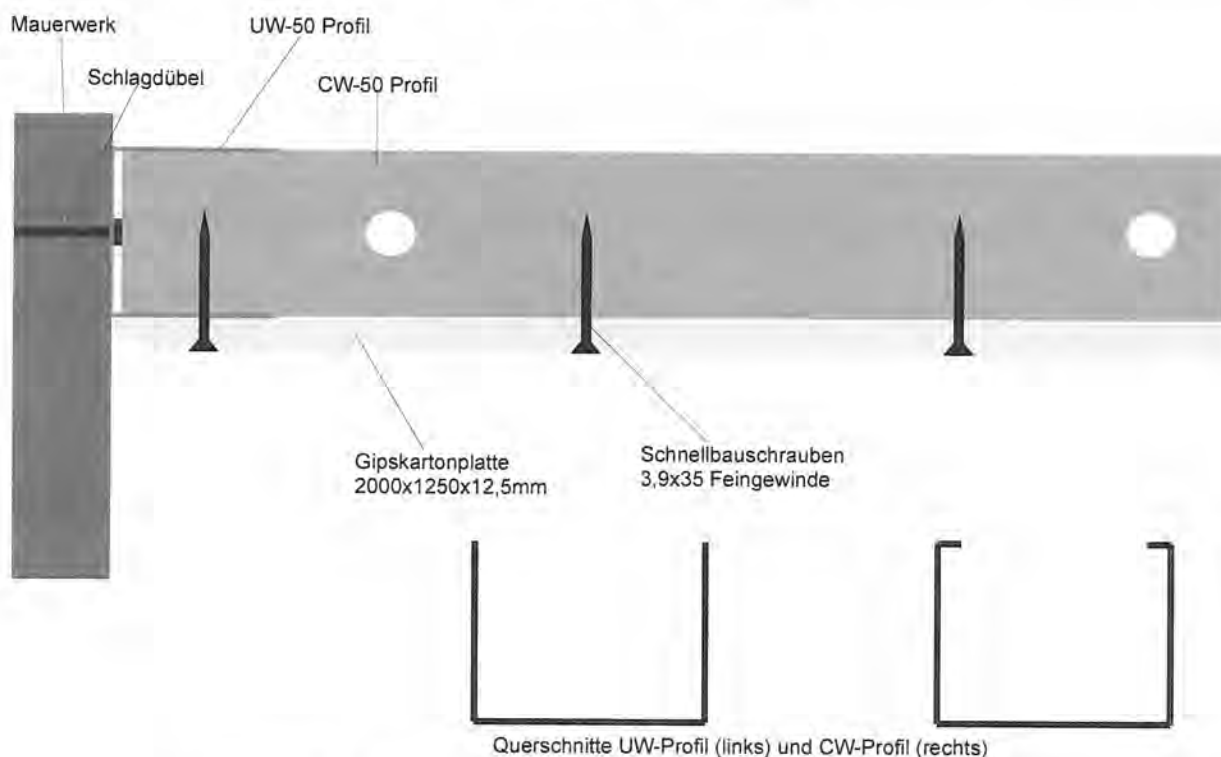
Trockenbau-Deckenkonstruktion mit CW und UW-Profilen
